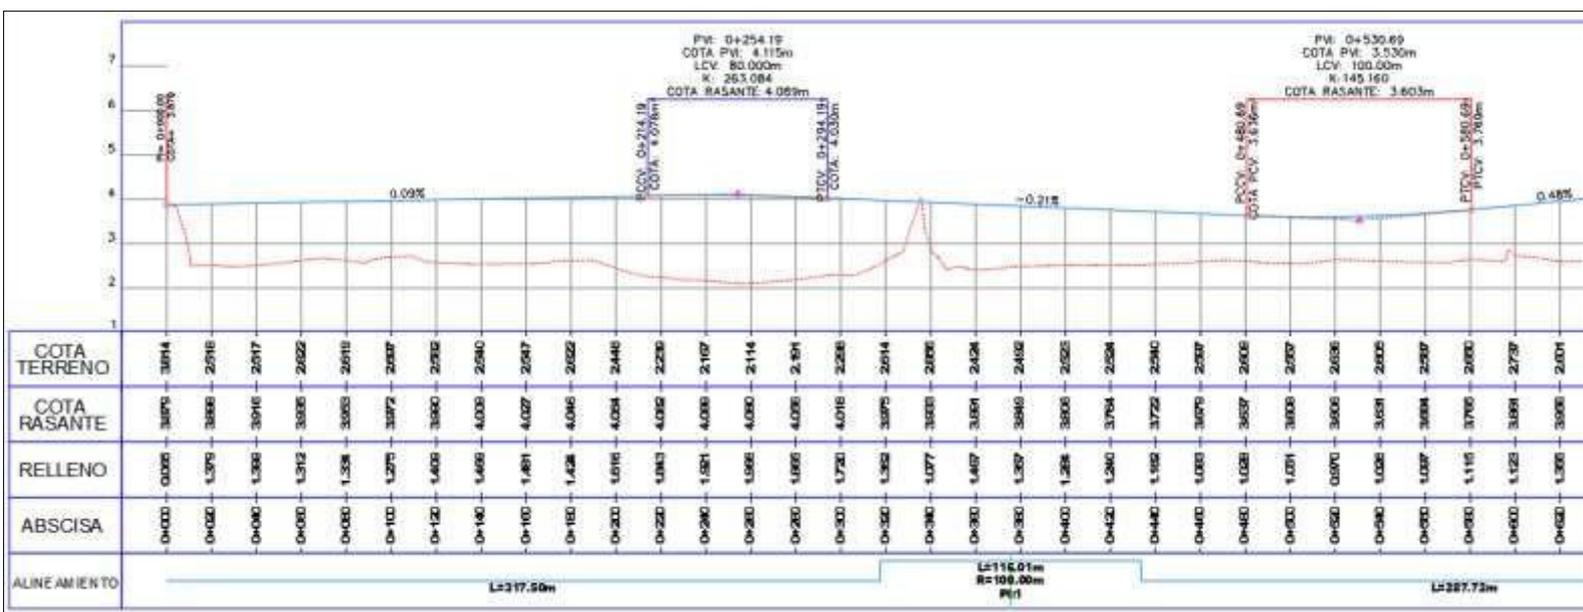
Detalle Perfil Longitudinal (Diseño Vertical) abscisas 0+000 a 0+640
